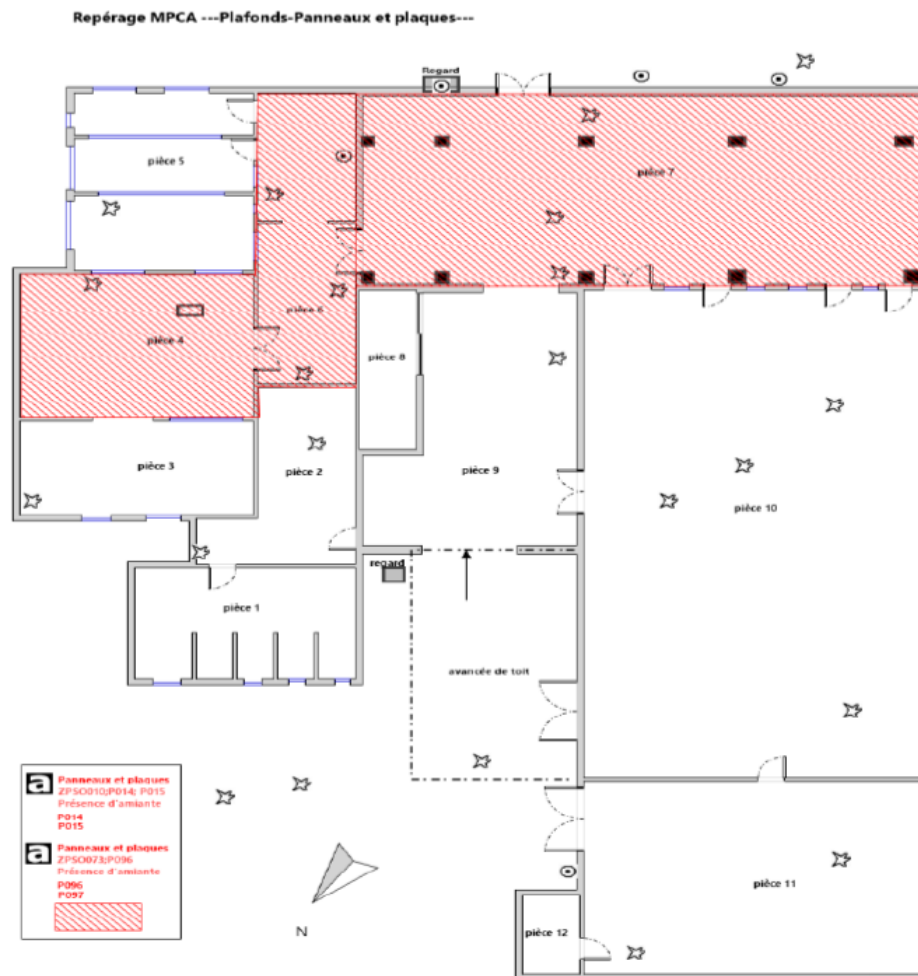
Plan des prélèvements au niveau des plafonds isolants sous toitures contenant de l'amiante dans le bâtiment 3
